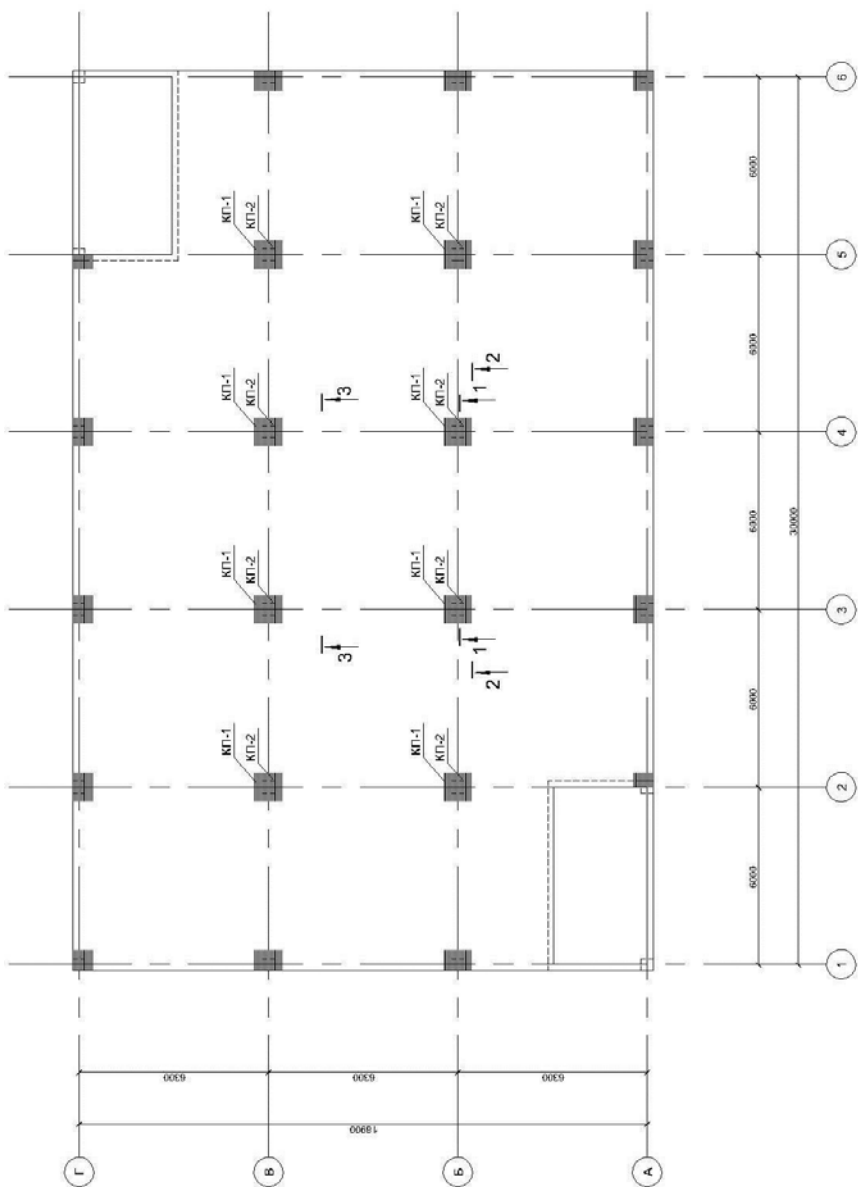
Дополнительное армирование плиты перекрытия в зонах продавливания
